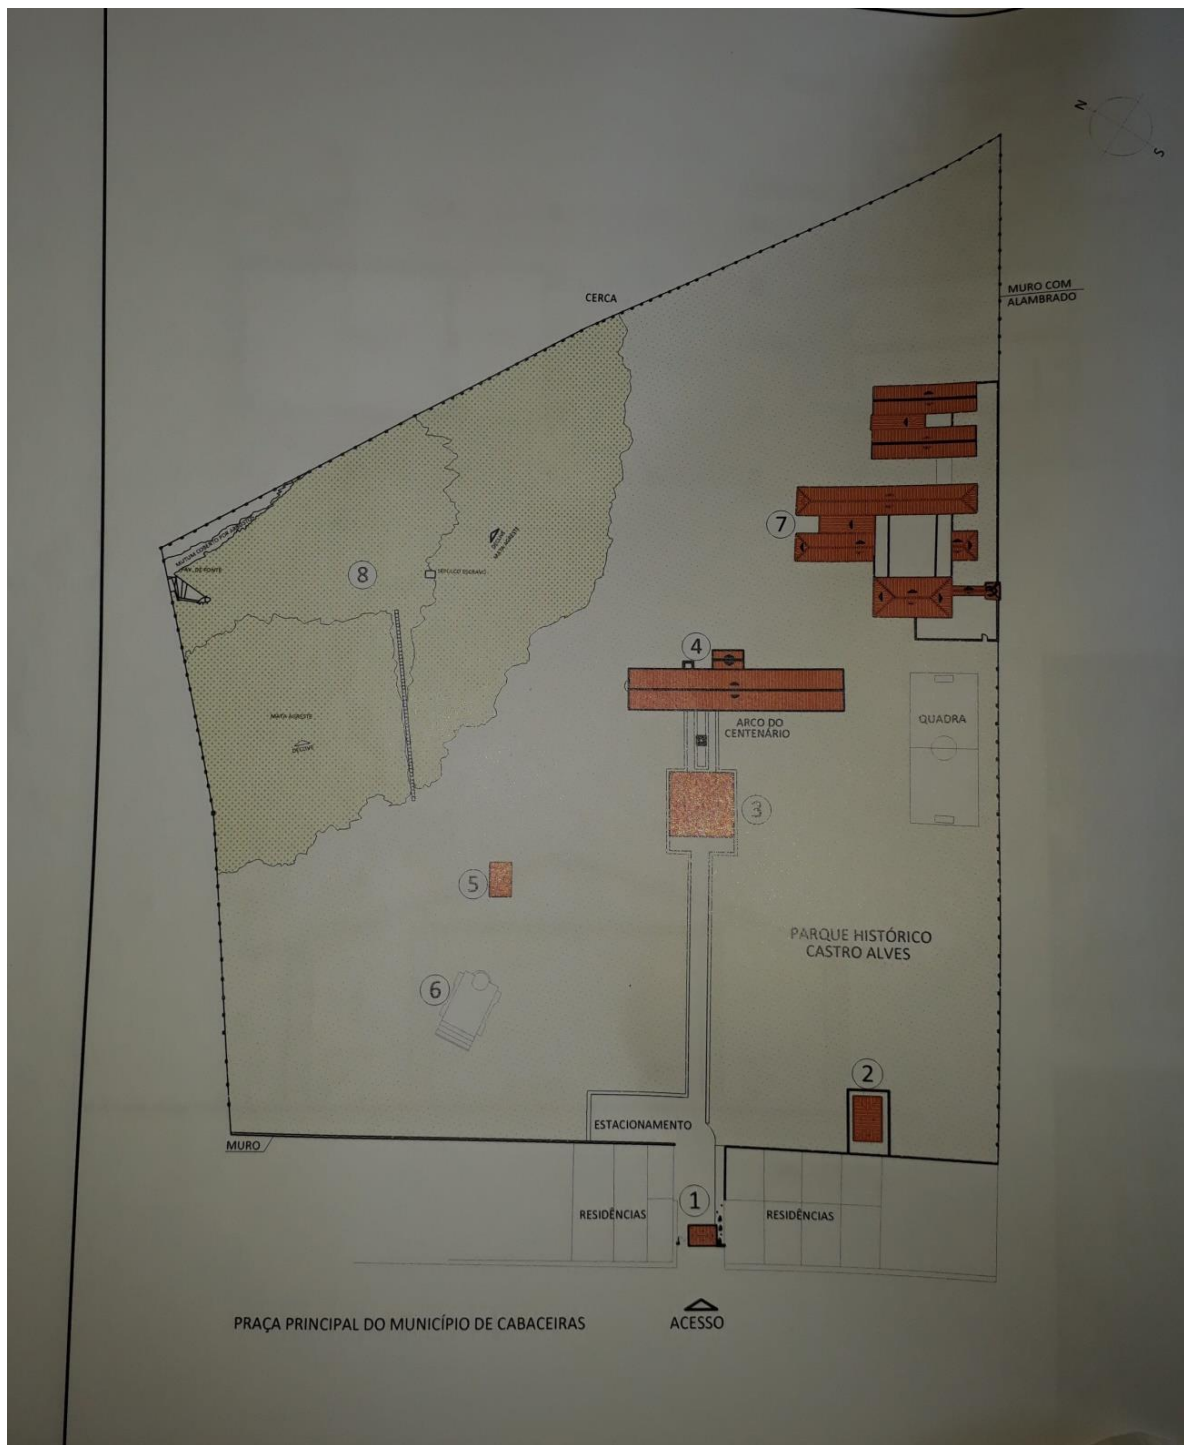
Planta baixa do terreno. Fonte: IPAC, 2011.
